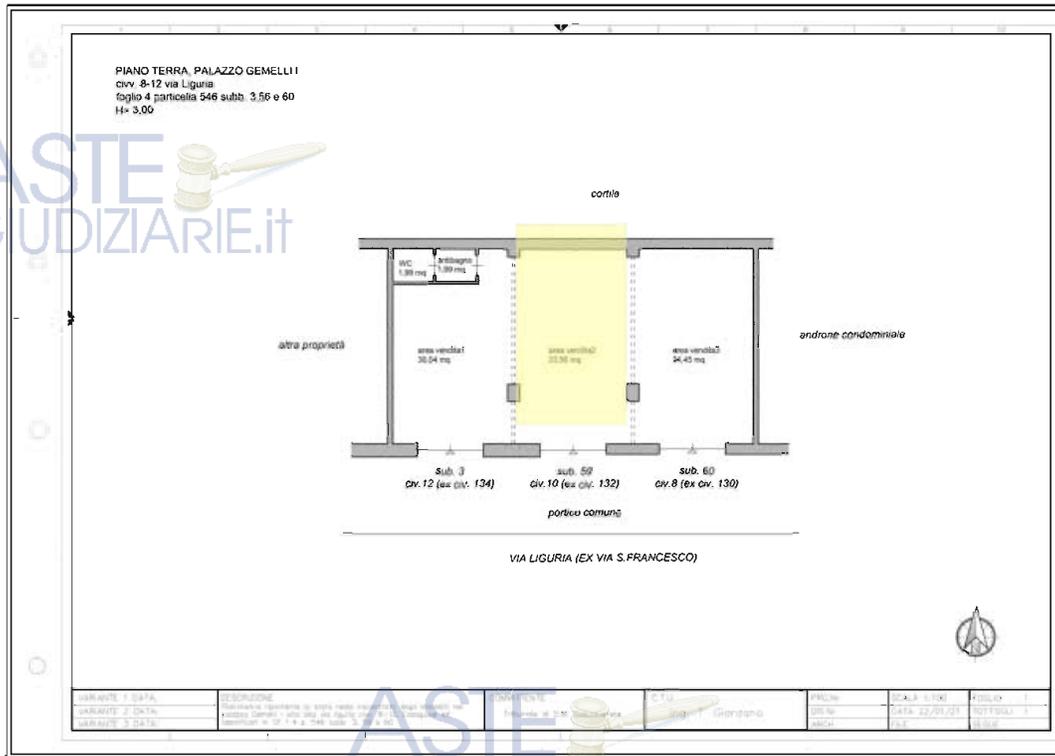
Pianta del minimarket con evidenziazione del LOTTO2
